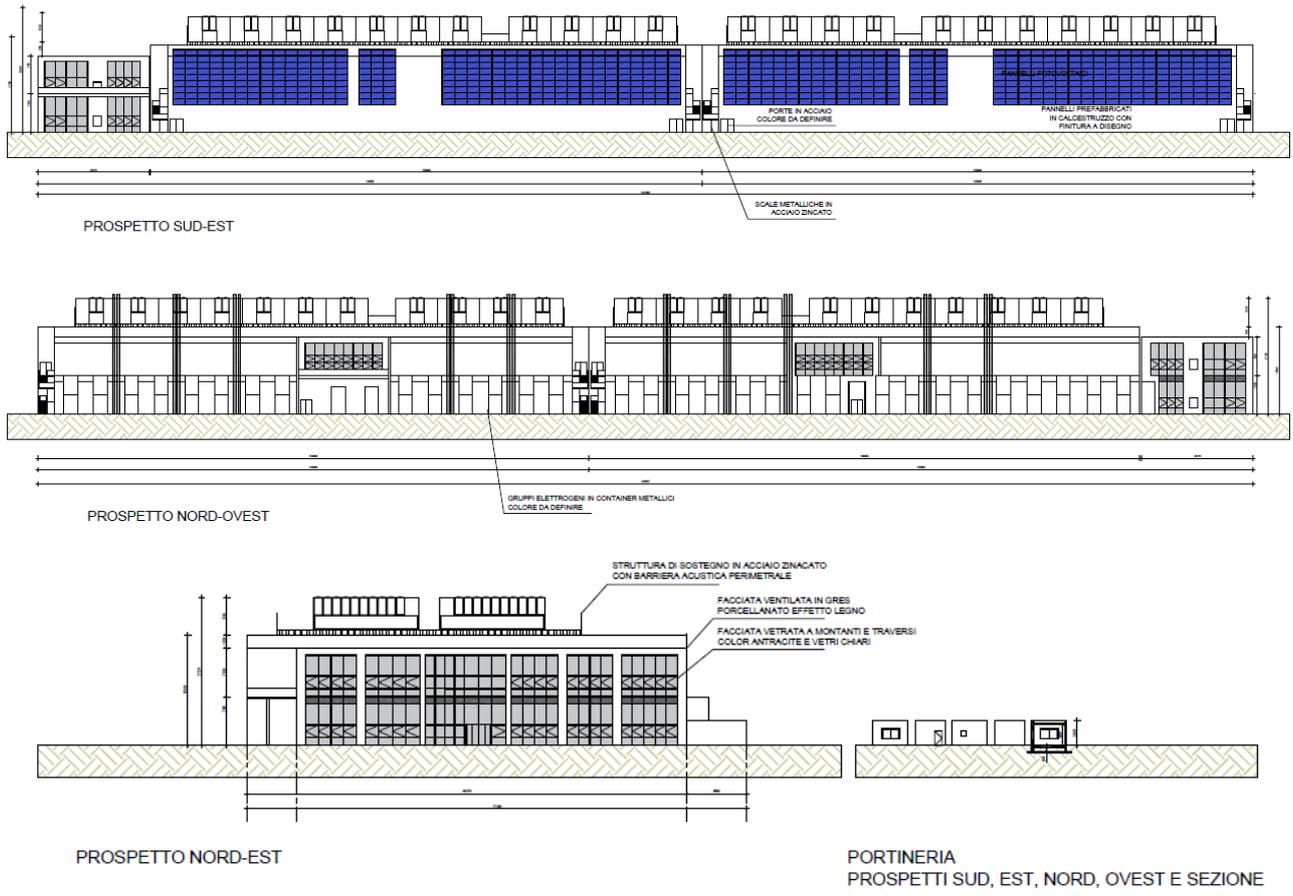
Prospetti nuovo edificio, tratti dalle tavole di progetto
